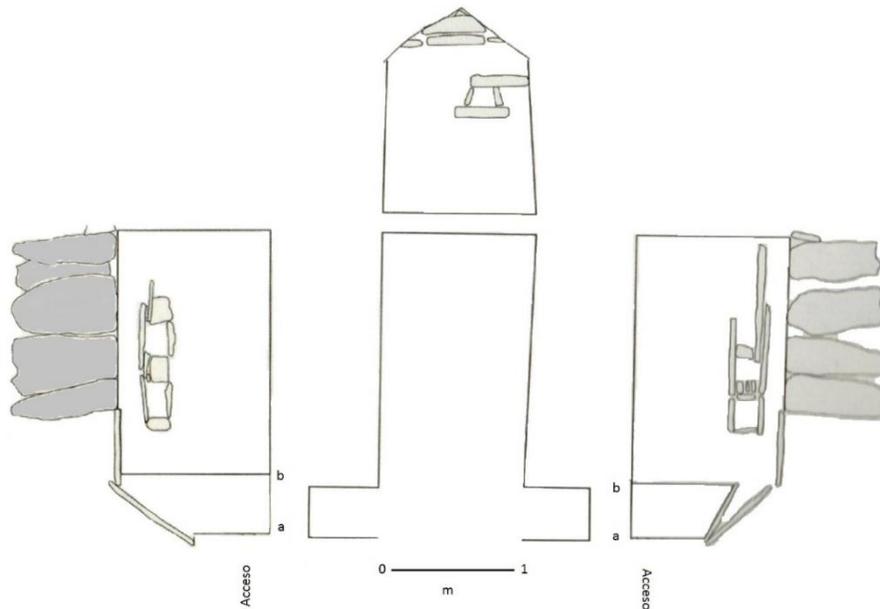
Planta y alzado de la Tumba en San Antonio del Barrio.
